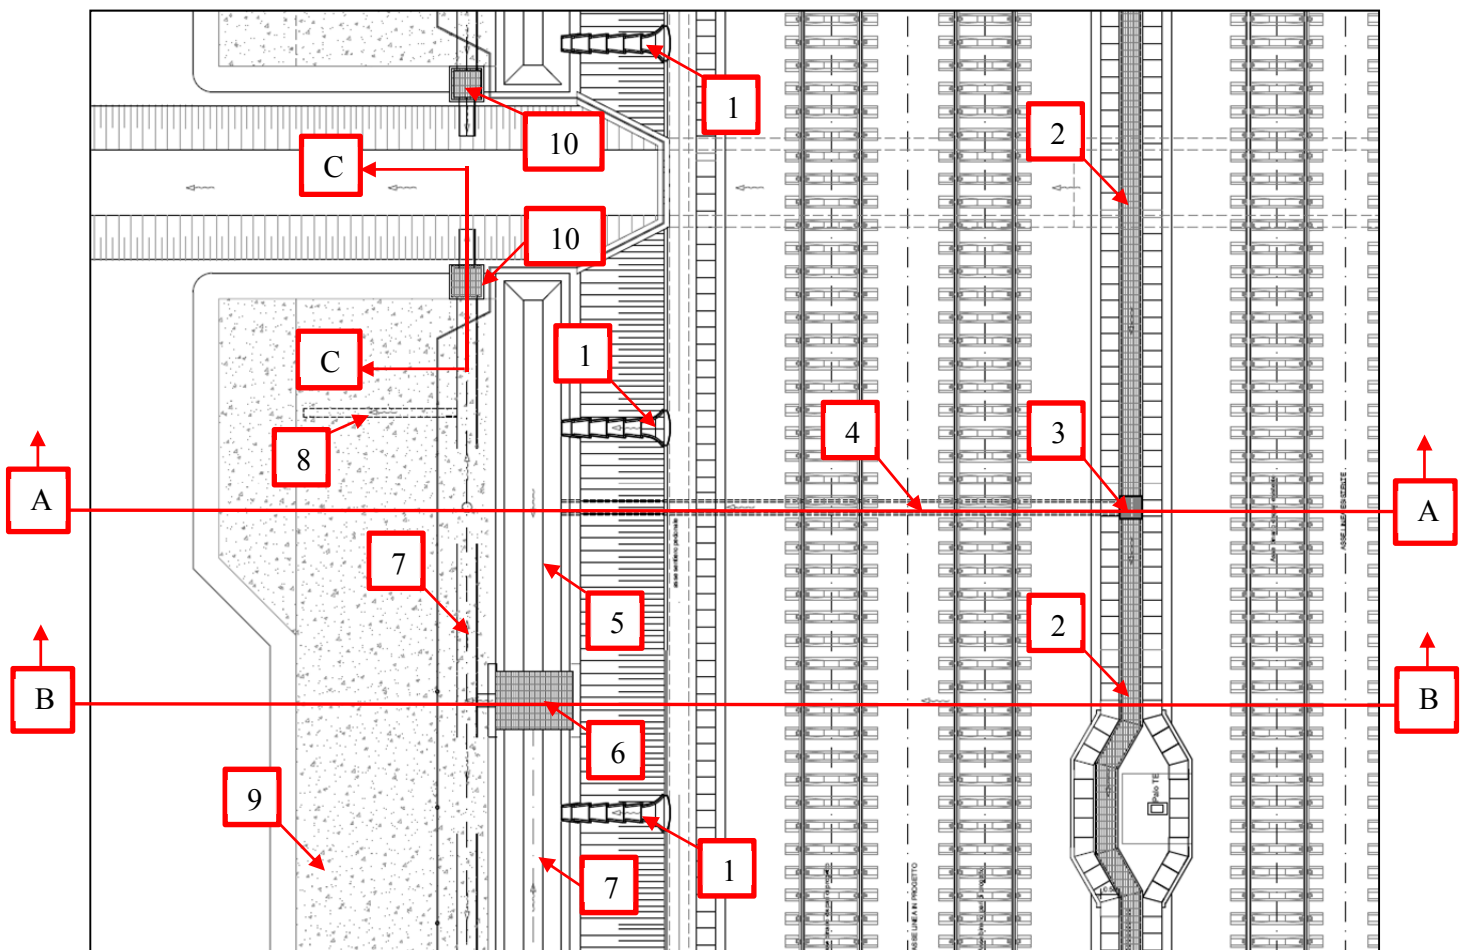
Stralcio planimetrico drenaggio tipologico di piattaforma
